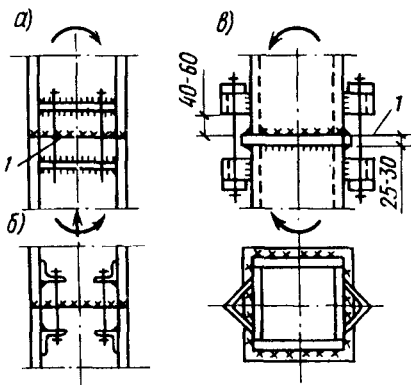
Сварные стыки колонн при больших эксцентриситетах
